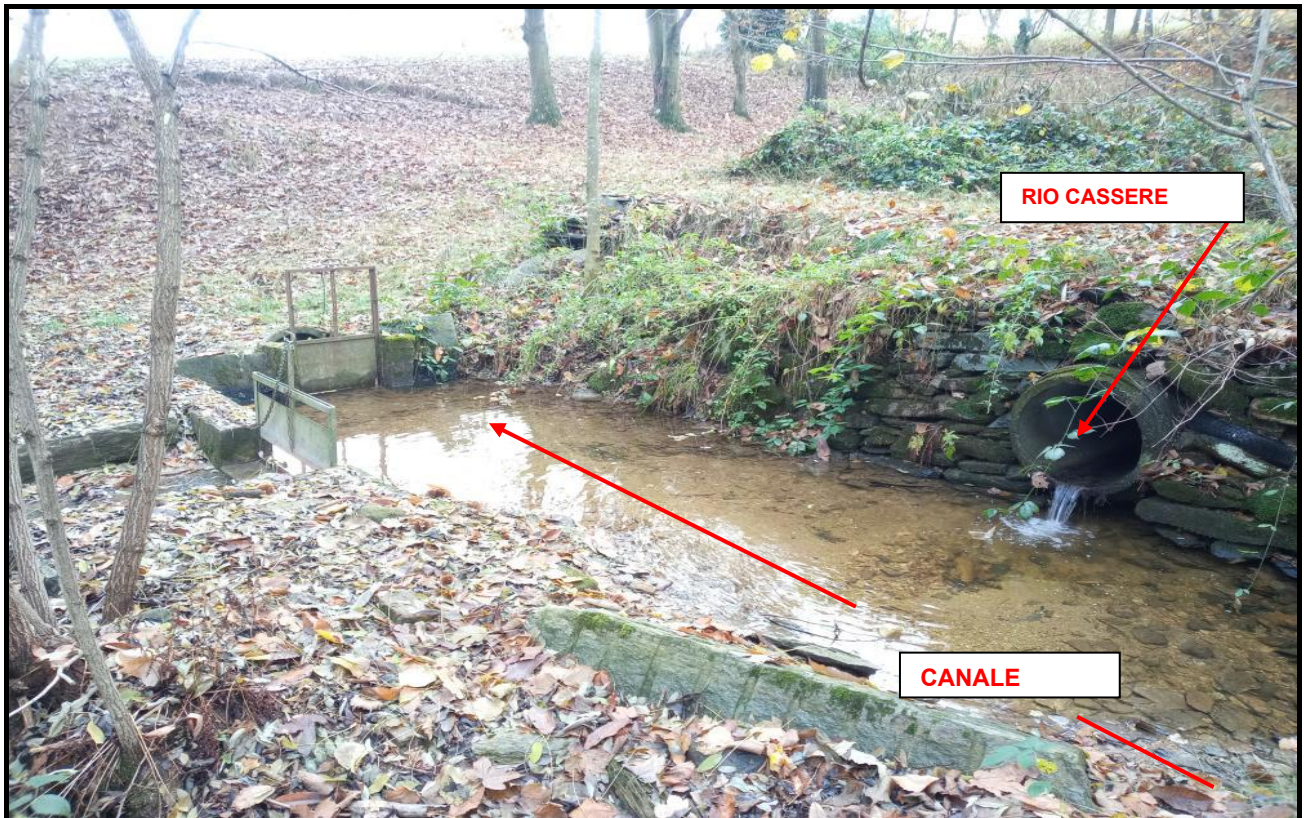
Intersezione canale Becetto – rio Cassere.
